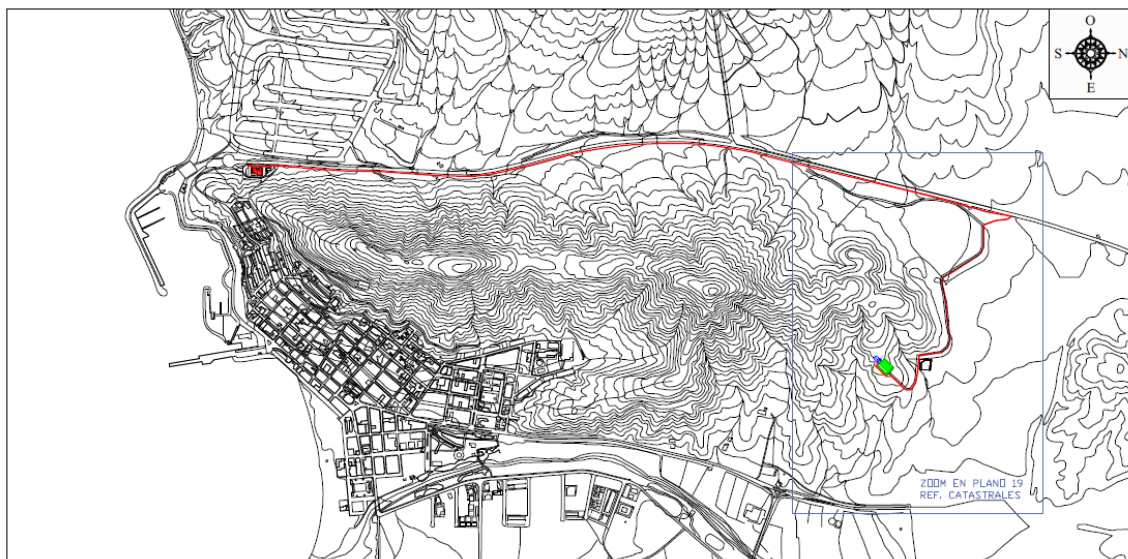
Trazado de la línea eléctrica. Plano 8. Trazado de la línea eléctrica.
